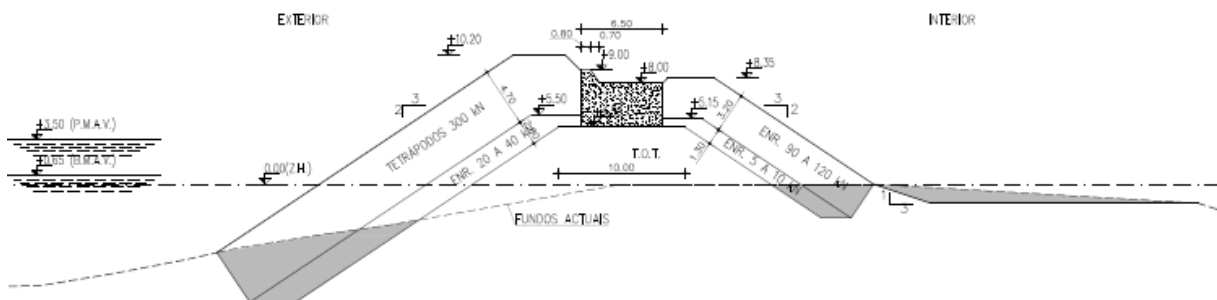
Perfil transversal tipo do tronco (zona a reconstruir)
